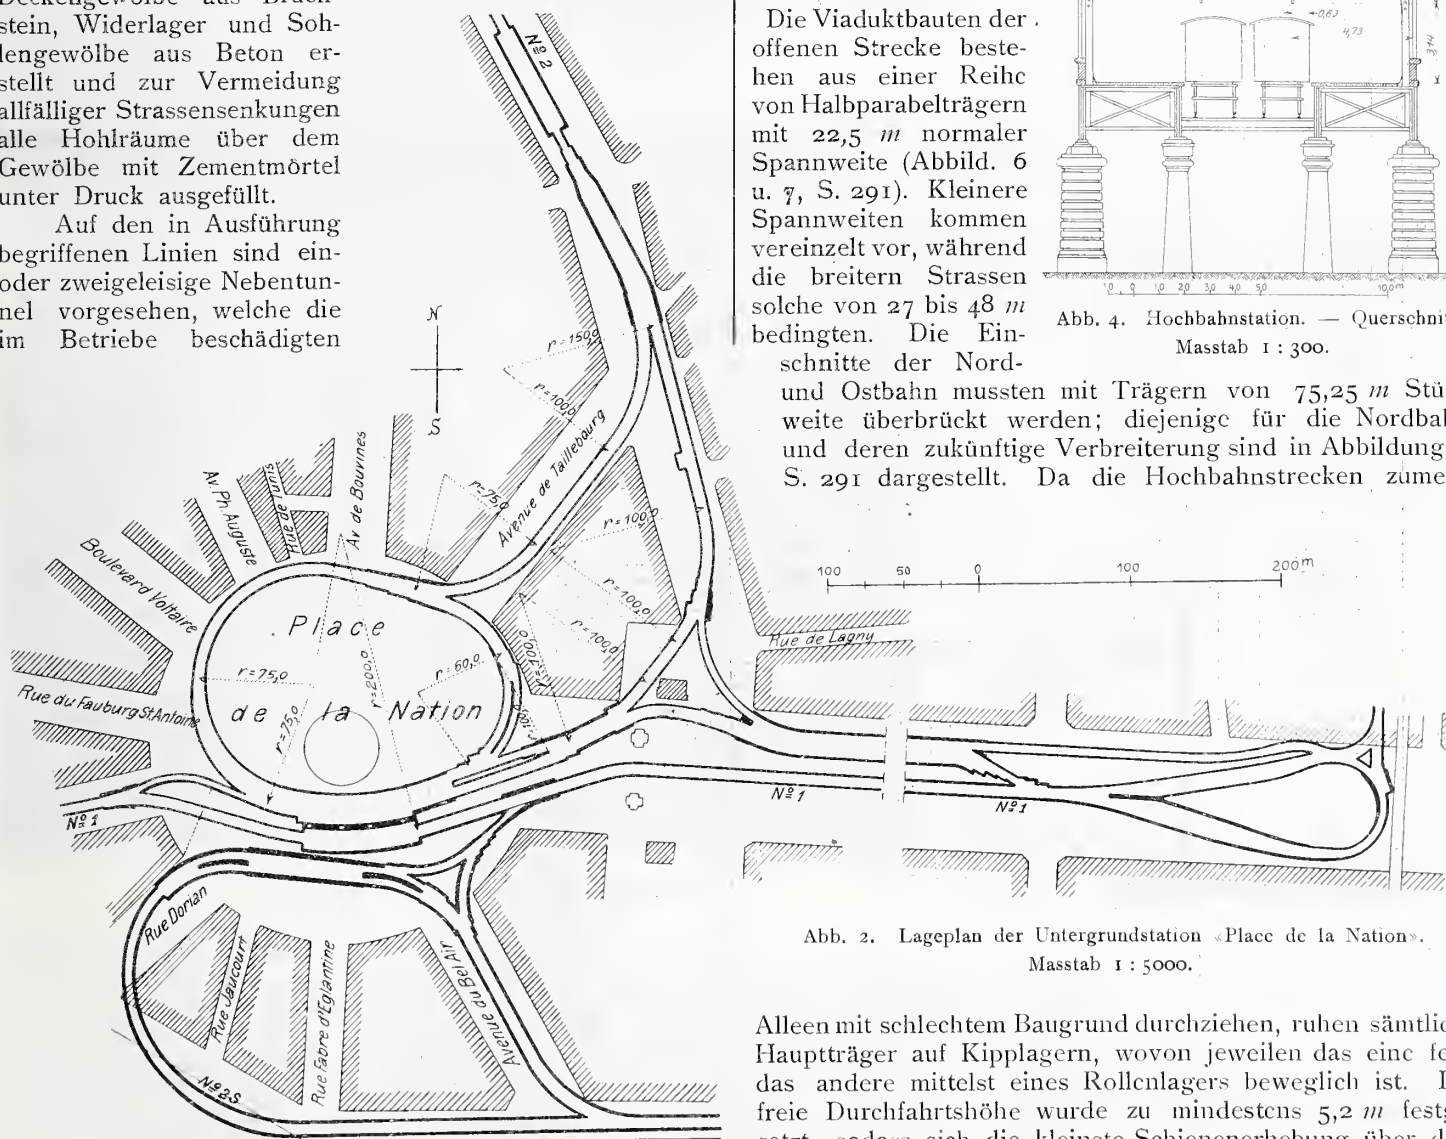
Lageplan der Untergrundstation «Place de la Nation».
